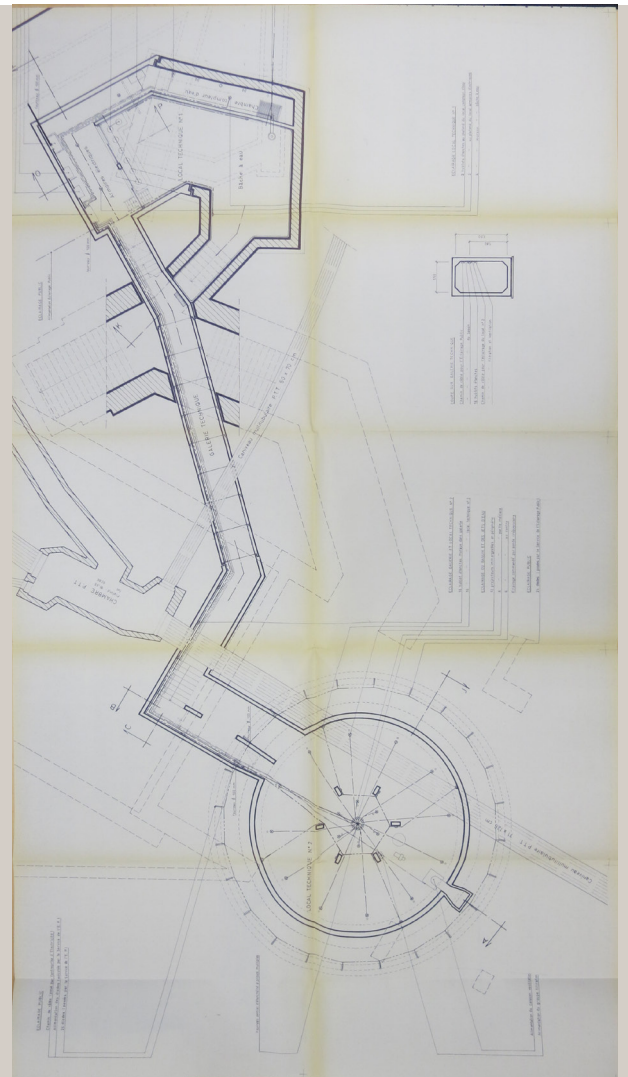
Plan des locaux techniques en sous-sol, 1990.
